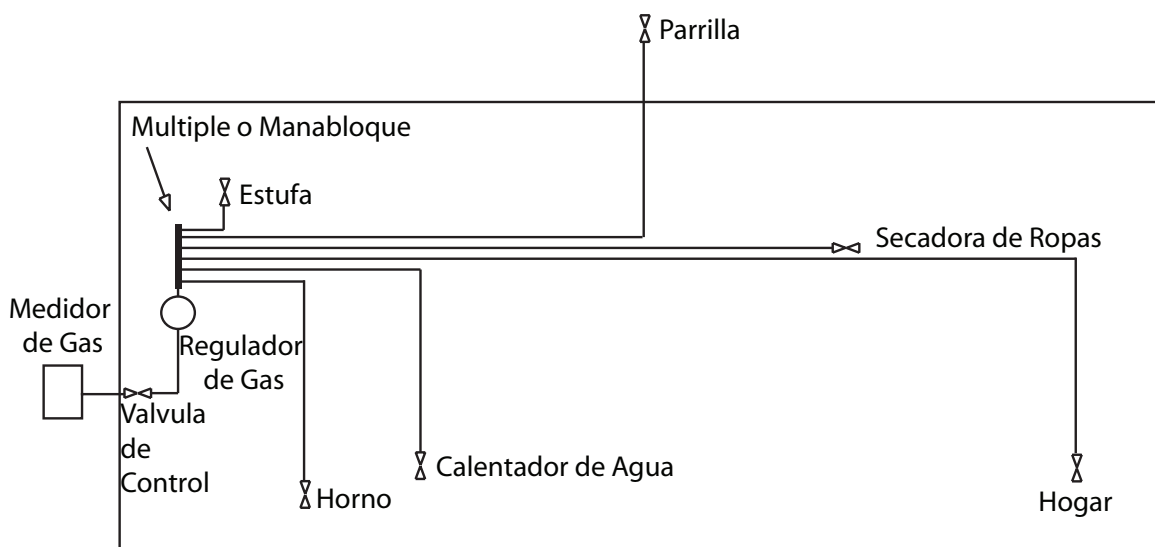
Plan de tubería residencial típica con tubería con monobloque de distribución
